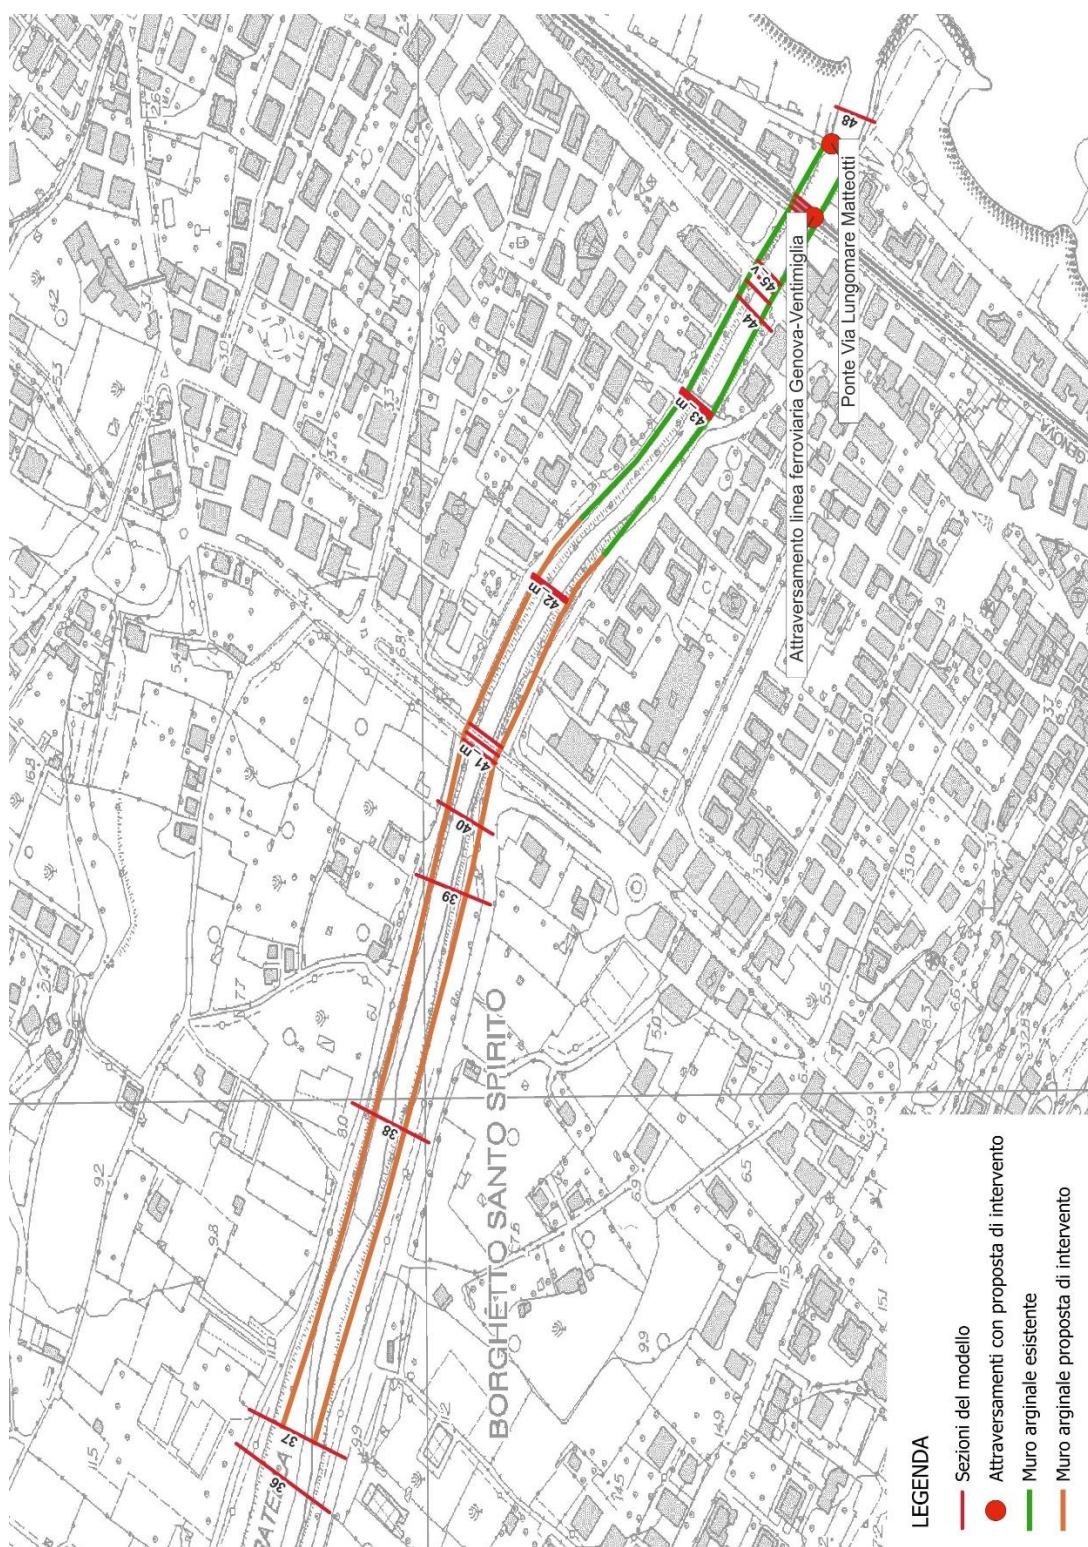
Planimetria di inquadramento degli interventi modellati.
